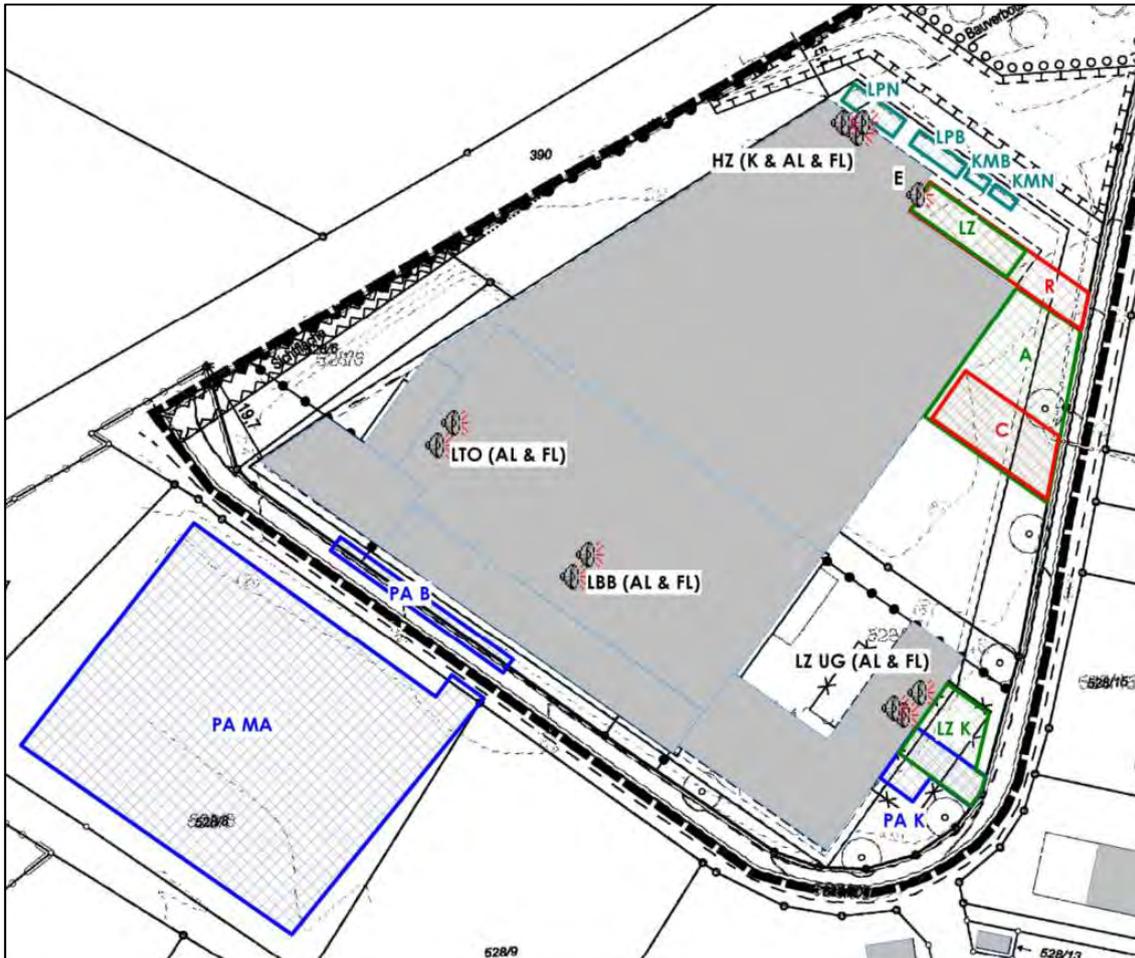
Lageplan mit Darstellung der relevanten Schallquellen
